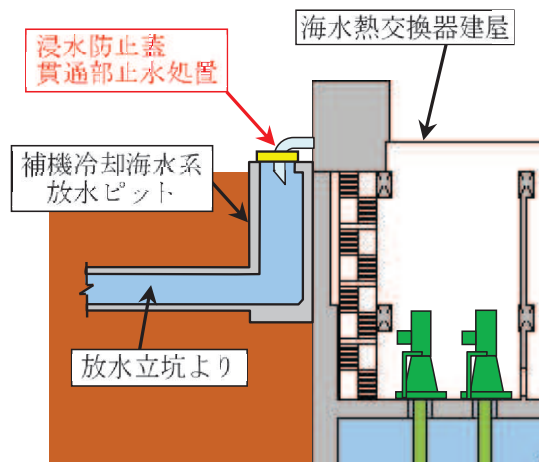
第 3 号機 放水立坑 流入対策配置図 (C-C 断面図)
